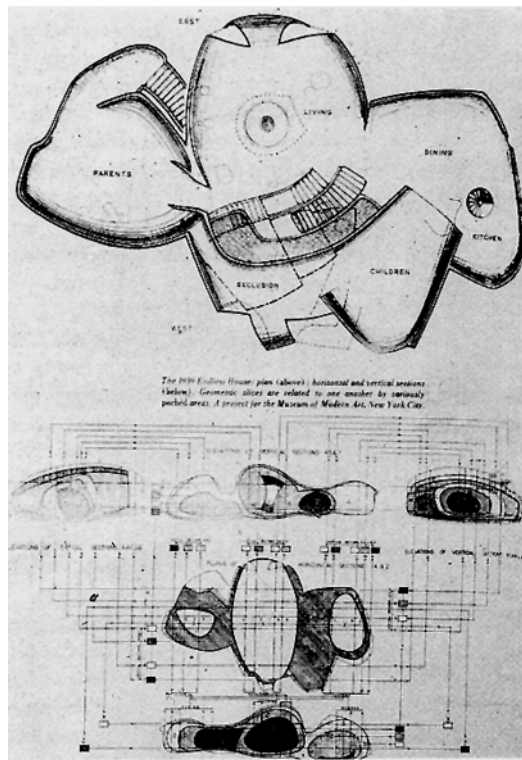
e: Frederick Kiesler, Endless House, Grundriss, 1949-1959¹⁹⁵
